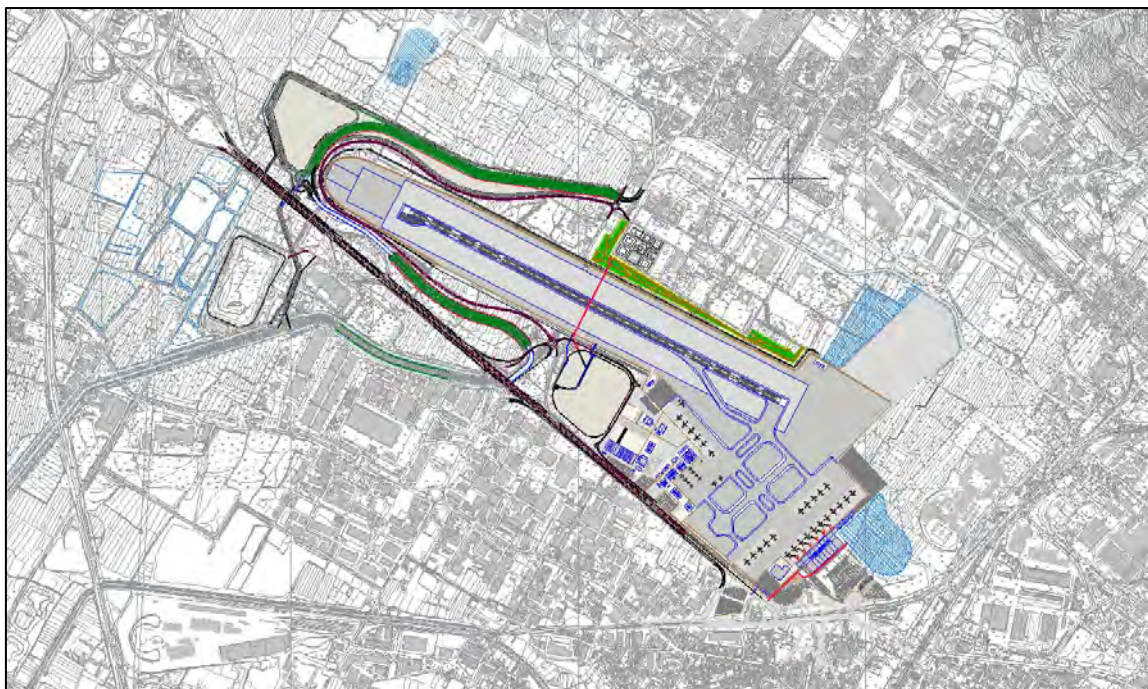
stralcio della planimetria di progetto dell'Aeroporto "Amerigo Vespucci"
